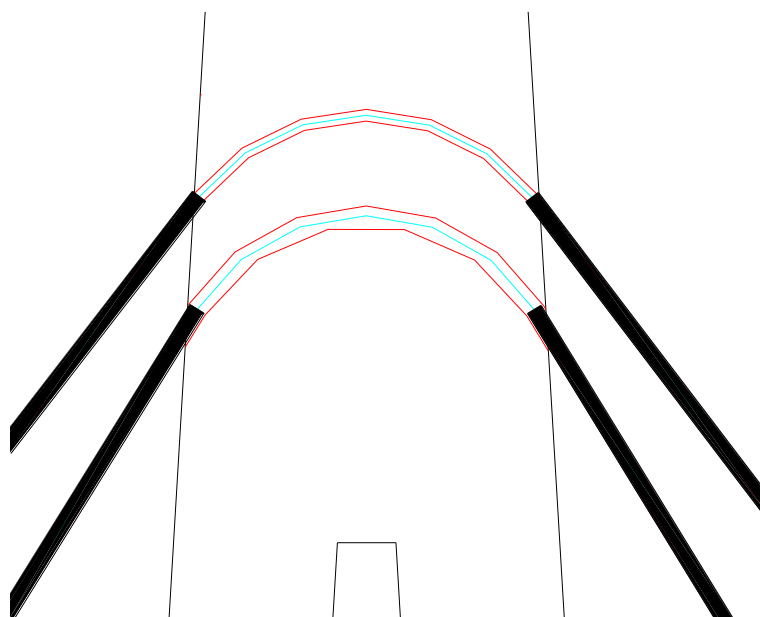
Pormenor das ancoragens superiores – ligações atirantadas
